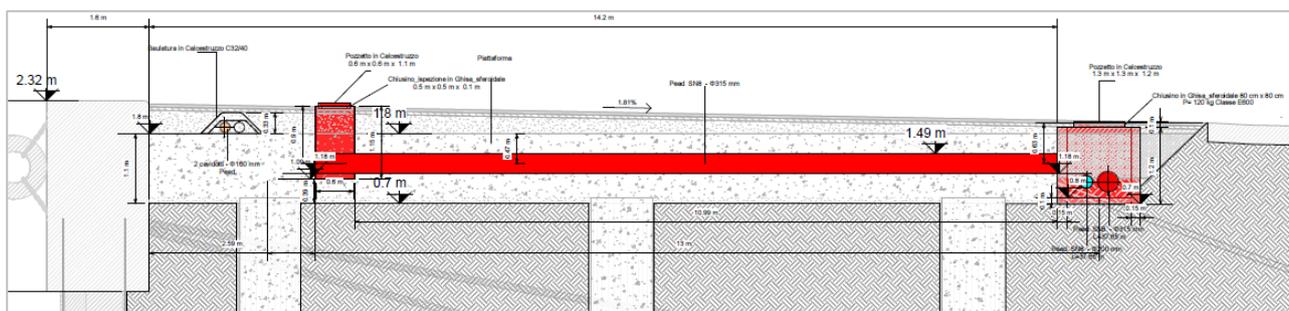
Sezione tipo predisposizione per stacco antincendio
